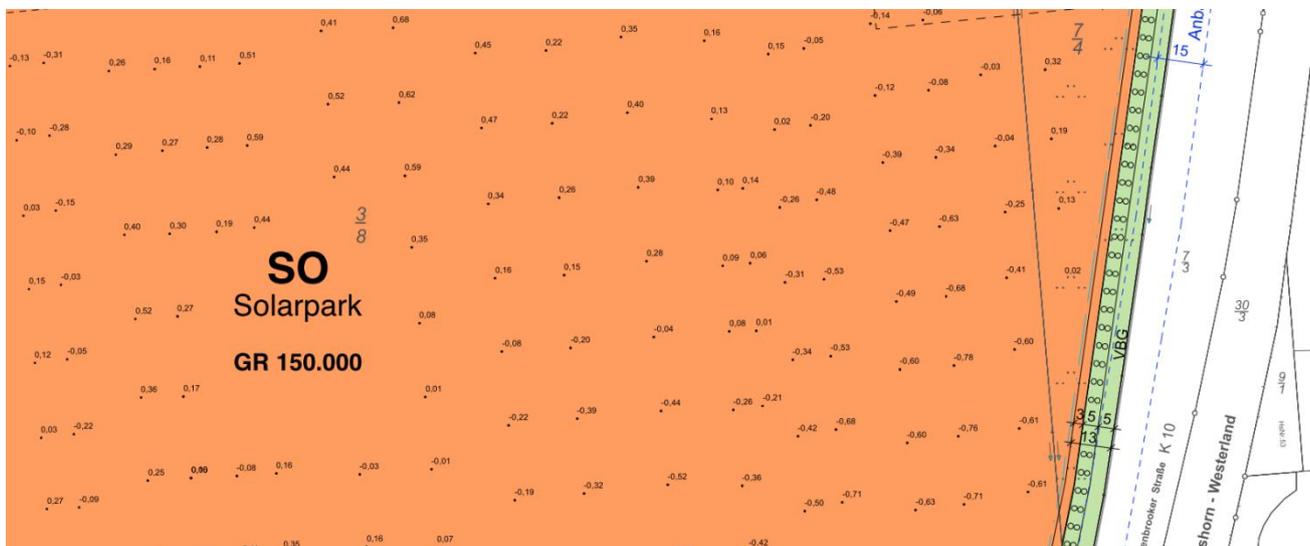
Ausschnitt aus dem aktuellen Bebauungsplan (Quelle: Planungsunterlagen)
